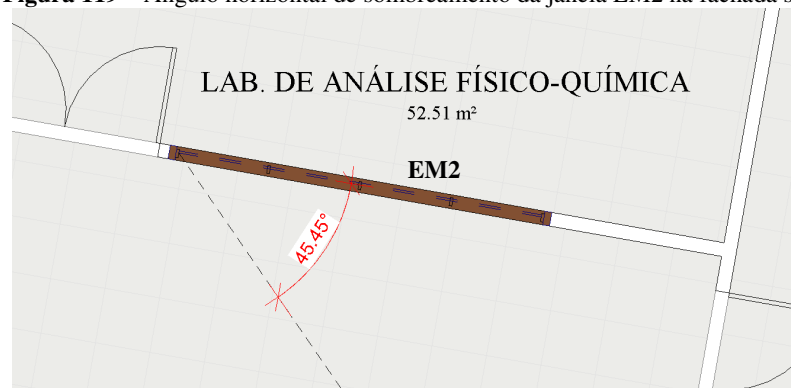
Ângulo horizontal de sombreamento da janela EM2-i na fachada sul
